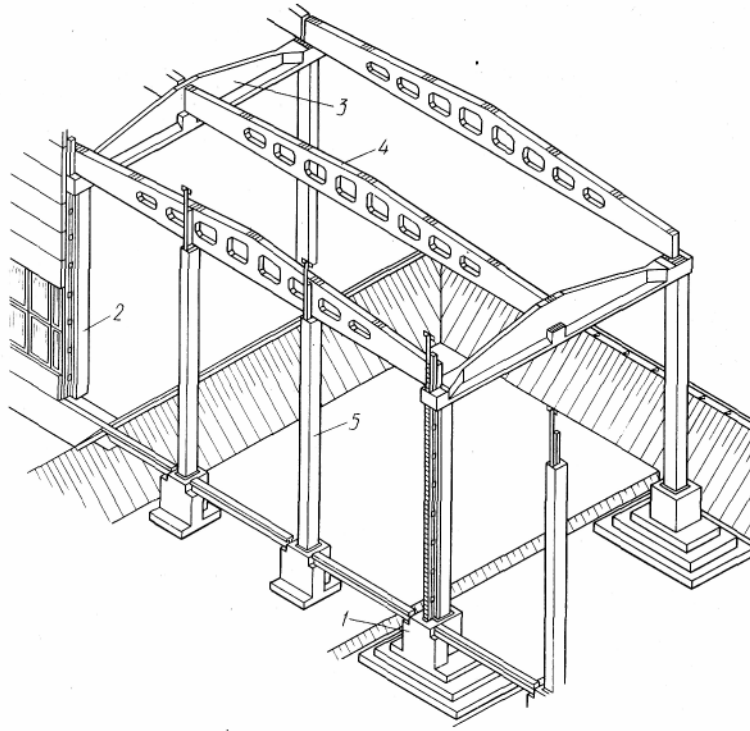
Залізобетонний каркас з кроквяними балками:
